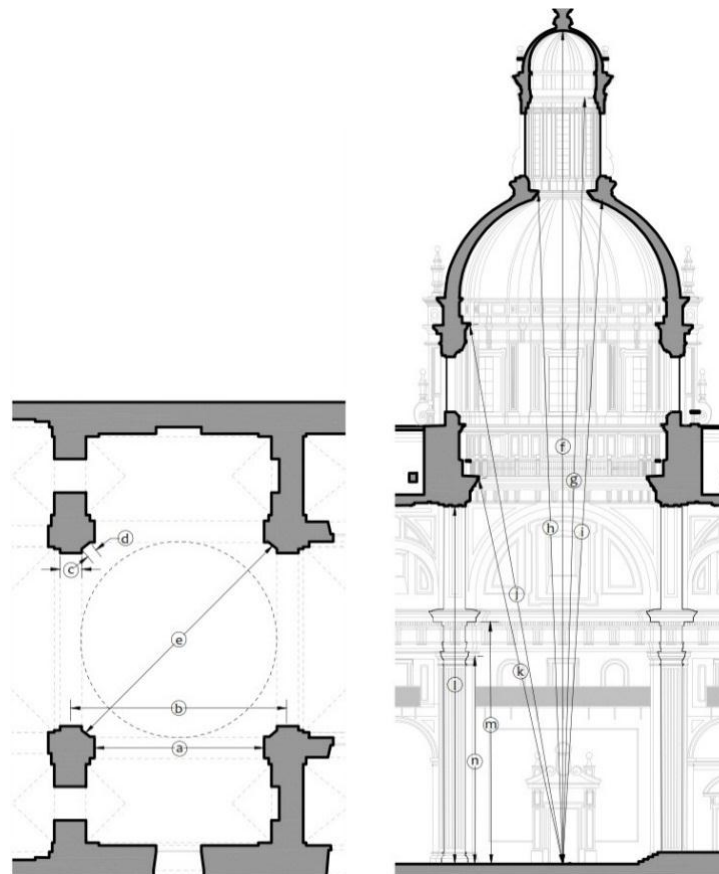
Croquis en planta y alzado de las distancias recogidas.
